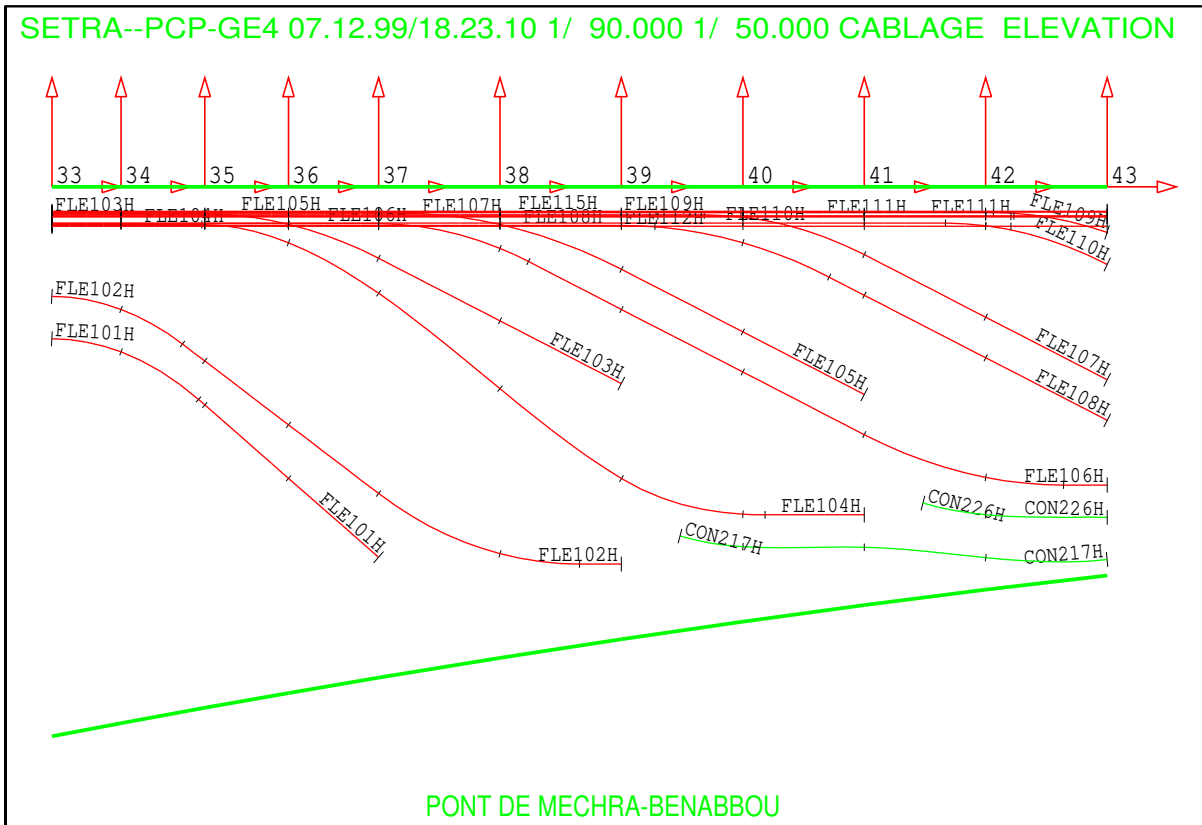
Tronçon de poutre spatiale, coupe longitudinale 3
